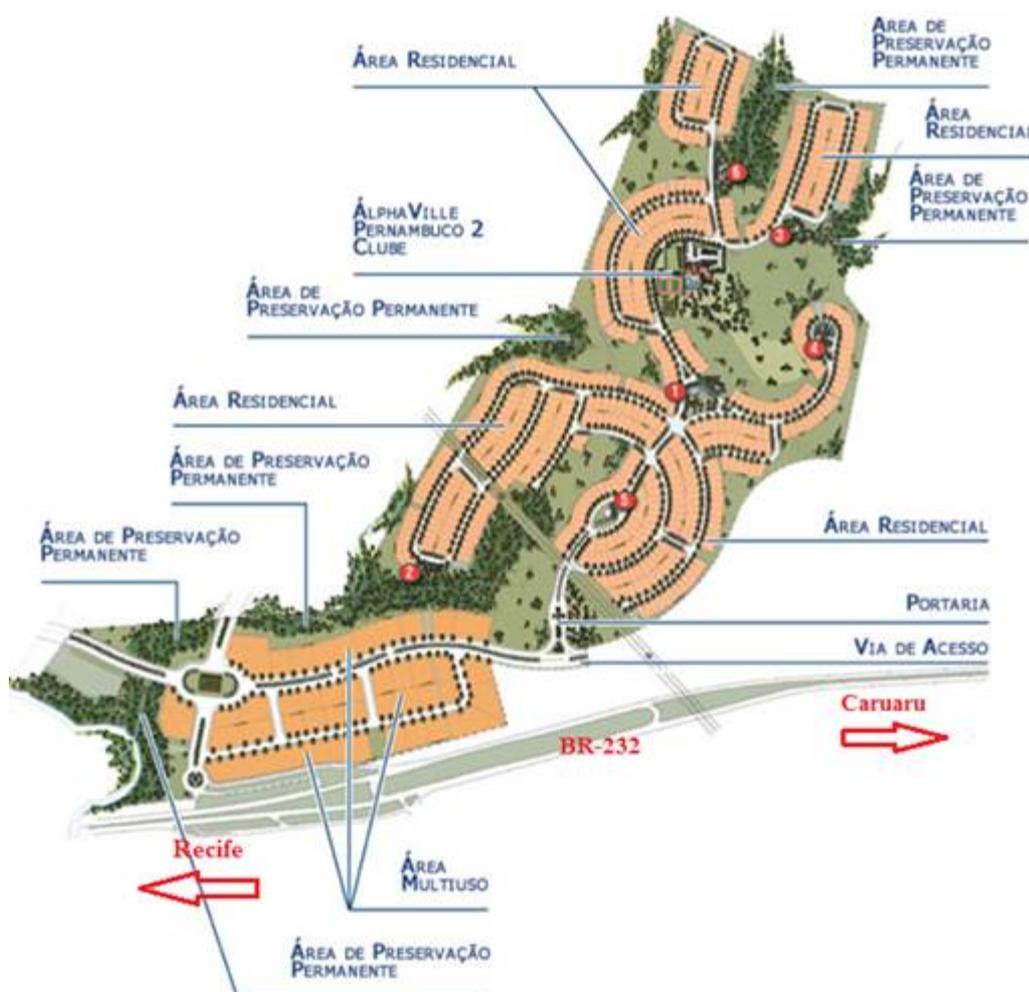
Planta conceitual do Alphaville Pernambuco 2, com a disposição dos lotes.
